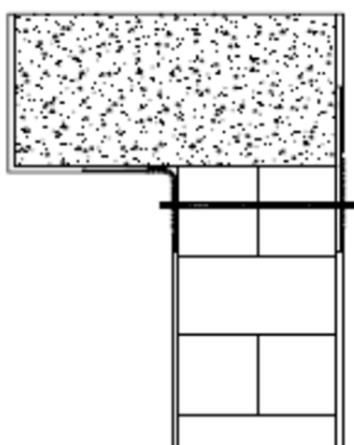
Conexión perimetral a placas y columnas (vista tridimensional): Paso 5.
